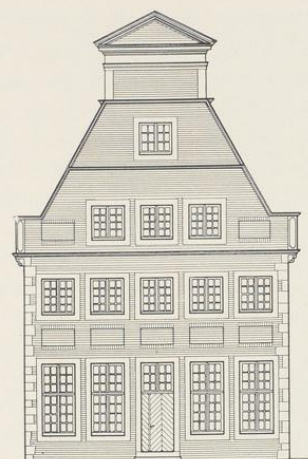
Rekonstruktion der Front des Hauses Ludgerstraße 53
